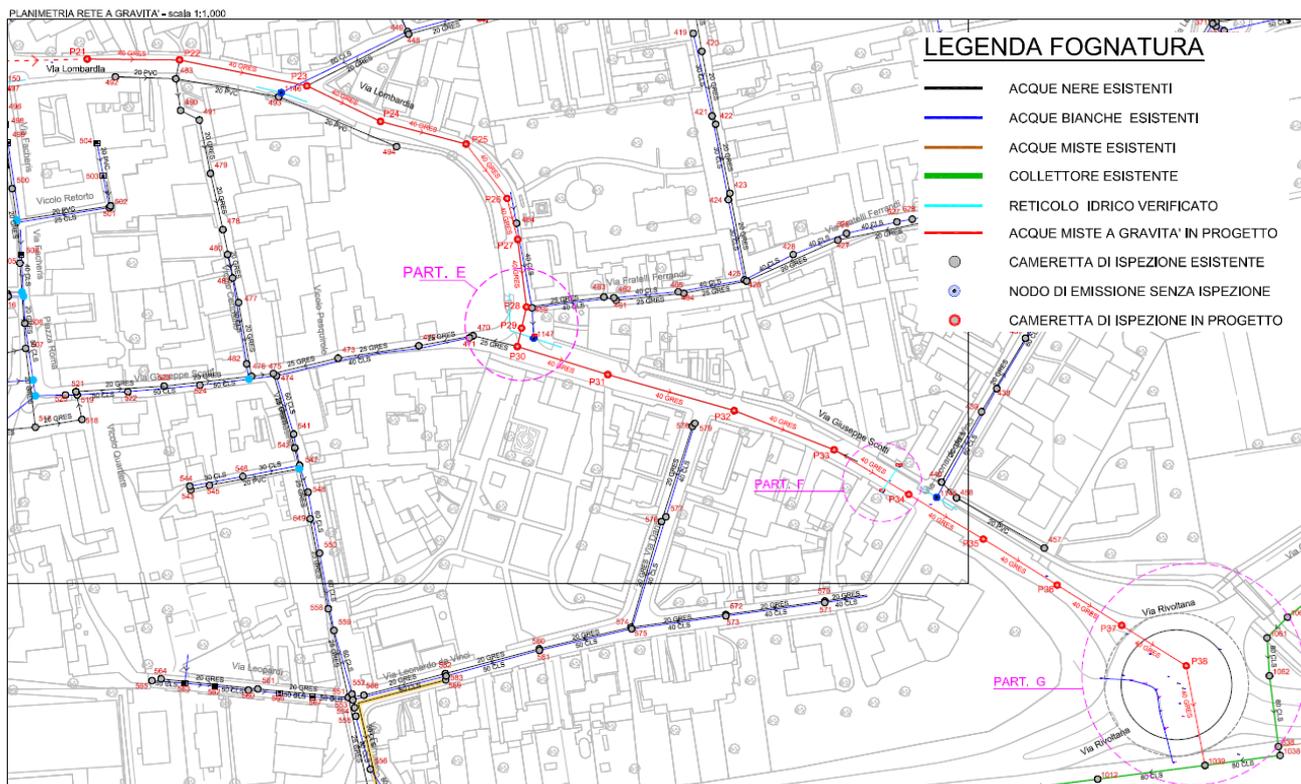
Planimetria Stato di Progetto – rete a gravità
